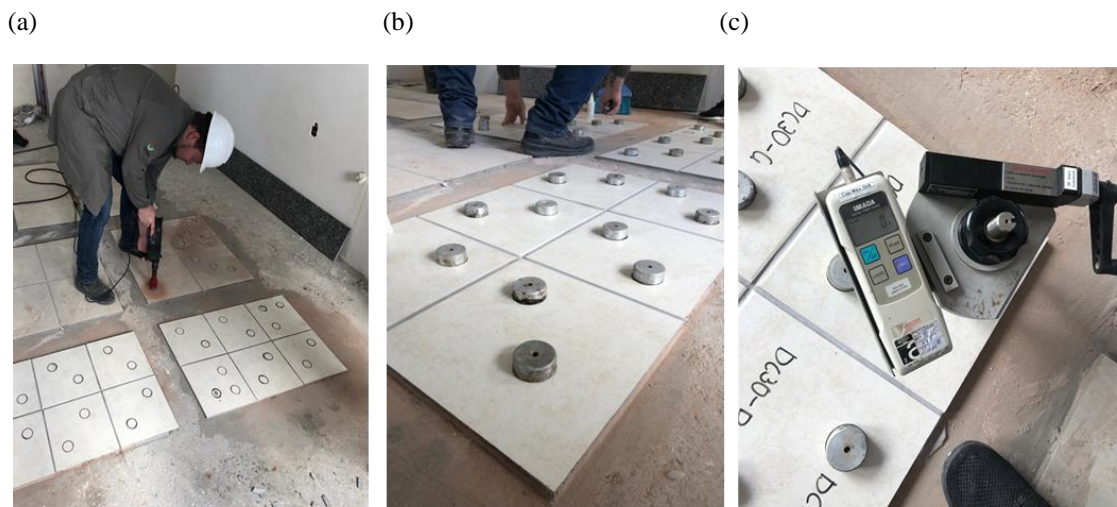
Execução de Ensaio de Aderência: (a) Corte da Placa Cerâmica, (b) Colagem da Pastilha Metálica, (c) Aplicação de Tensão com o Dinamômetro.
